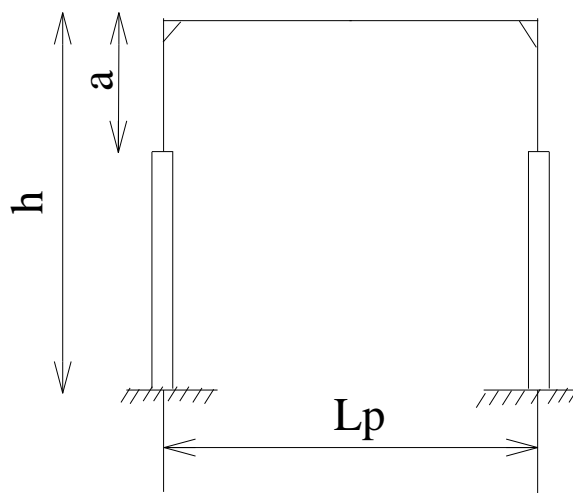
Расчетная схема поперечной рамы цеха
